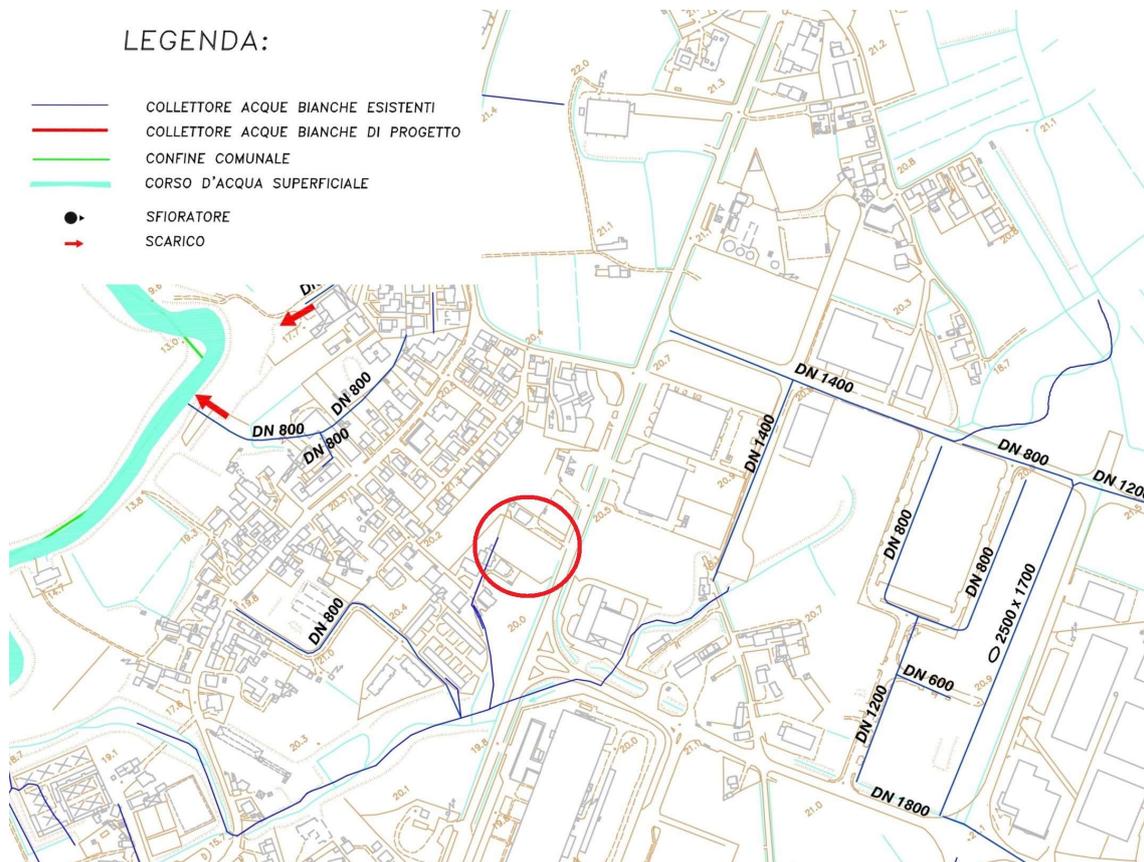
Planimetria Progetto Generale Rete Fognaria
